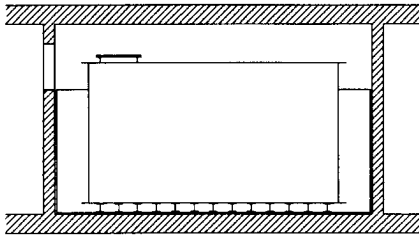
Bei über 5.000 l Fassungsvermögen ist ein separater Lagerraum mit Auffangwanne vorgeschrieben.
